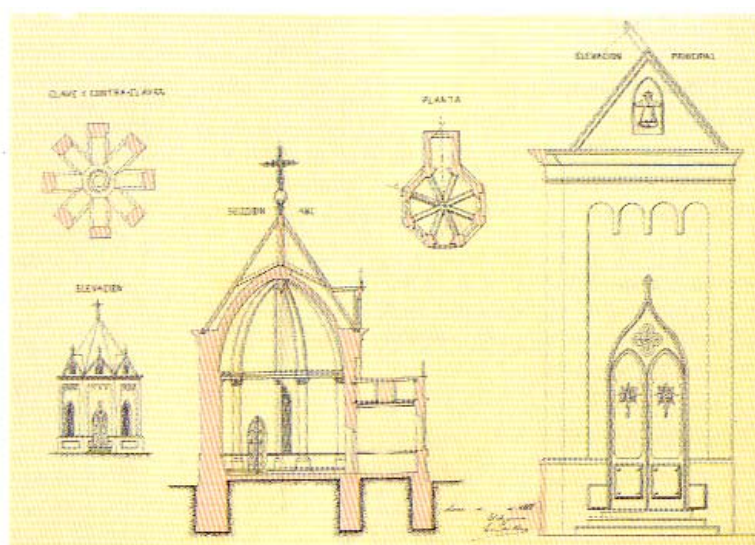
Planta, sección y alzado de la capilla. Ingeniero Riera. 1888
